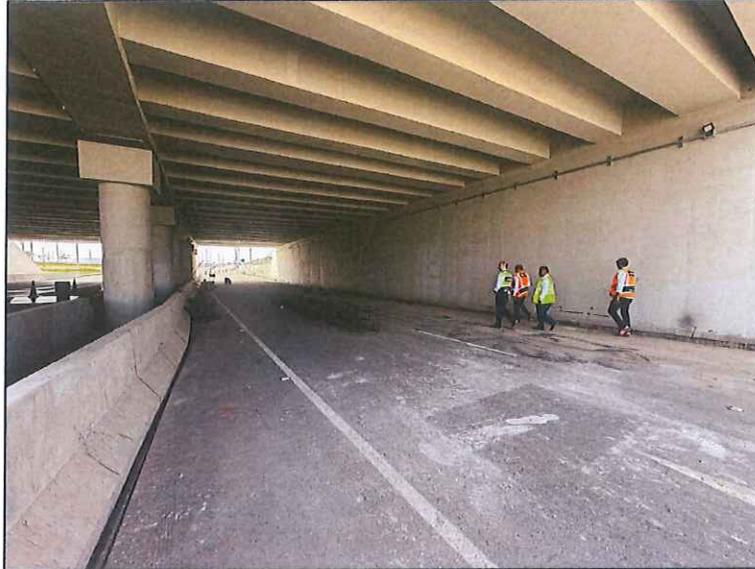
Paso inferior Santa Rosa. Se realizó inspección en el paso inferior Santa Rosa, evidenciando los trabajos de corte del pavimento y armado de acero para las canaletas que recogerán las aguas de escorrentía.
